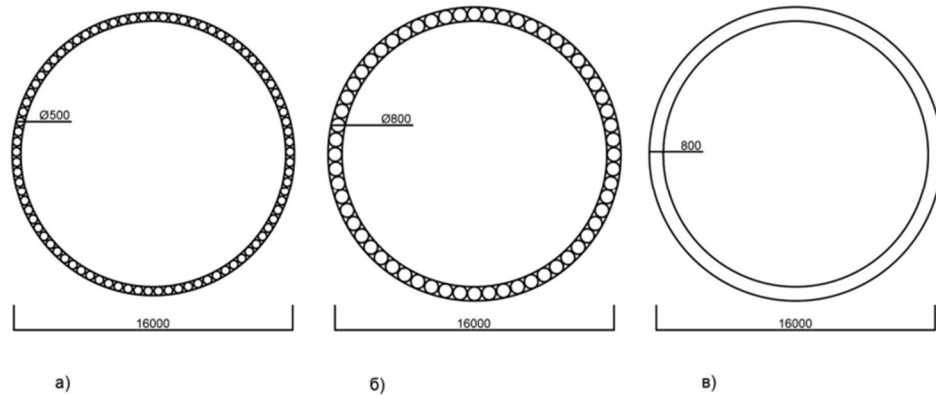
Схема розміщення паль та схема фундаменту з суцільної стінки :
